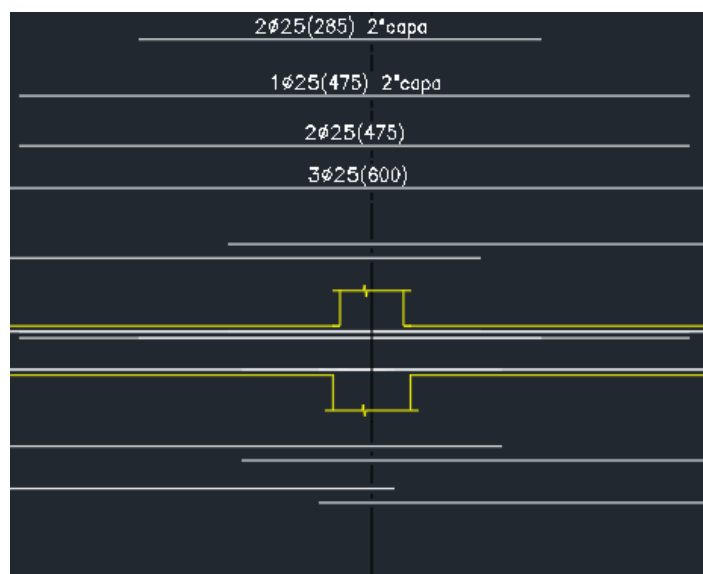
Detalle de armadura de refuerzo dispuesta en 2 capas en la unión viga – pilar. (Fuente: Cypecad)
